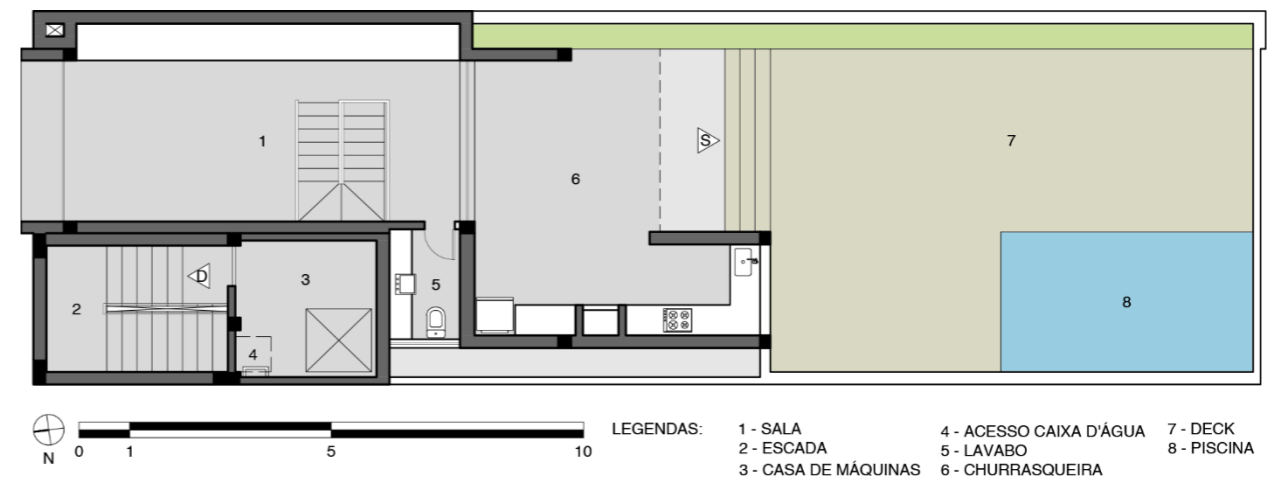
Planta do sexto pavimento do Residencial Flor de Liz
